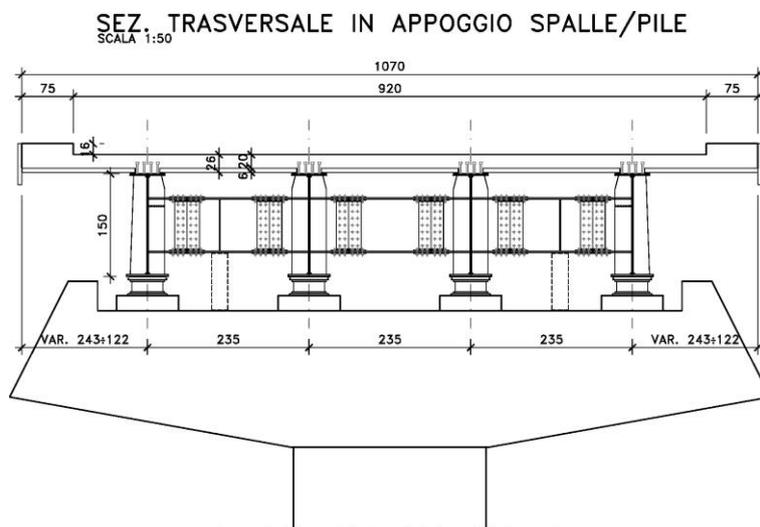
Sezione trasversale nuovo impalcato a 4 travi – Sezione in asse appoggi
